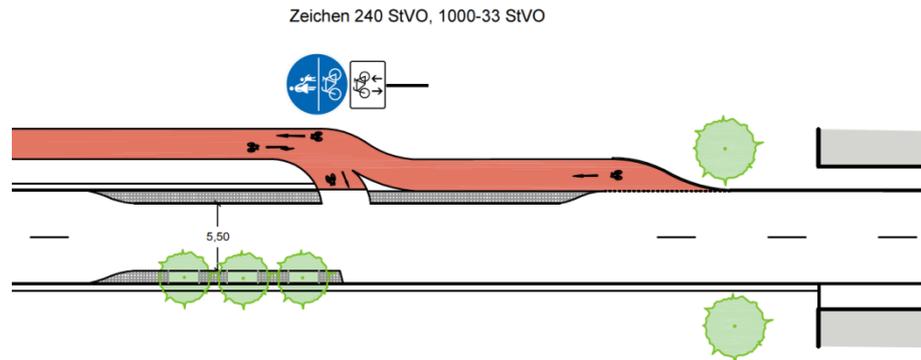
Muster für einen Wechsel der Führungsform ohne Mittelinsel
